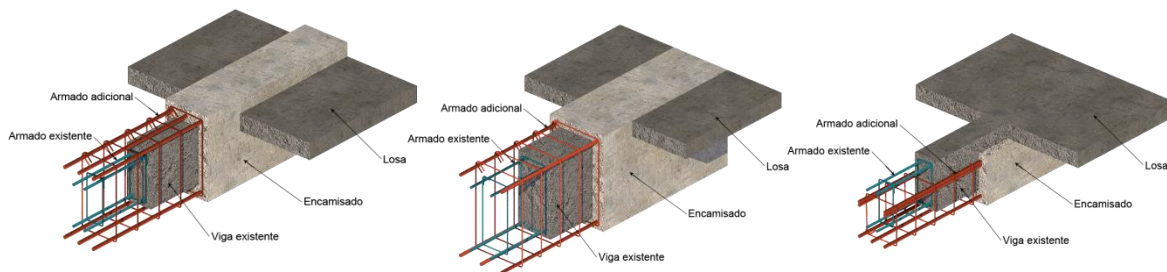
Posibles configuraciones de encamisado de vigas con concreto: a) encamisado sobre nivel superior de losa; b) encamisado al nivel del piso; c) encamisado por debajo de la losa.
